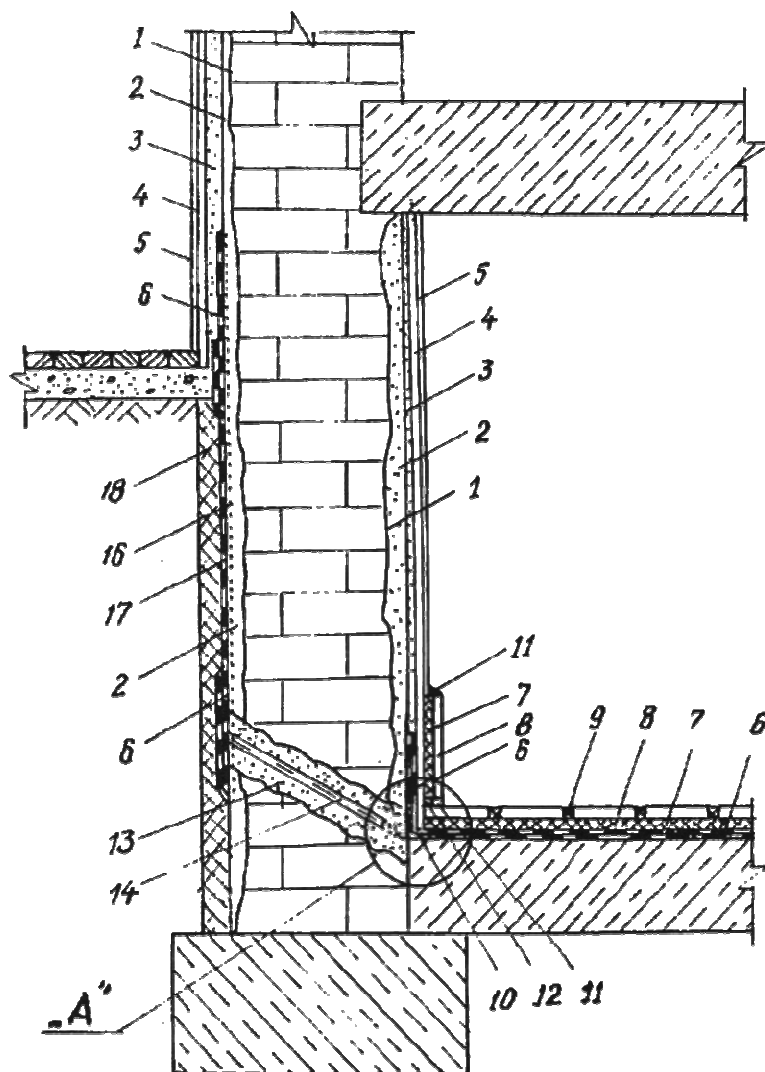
Устройство отсекающей гидроизоляции на уровне пола подвала:
